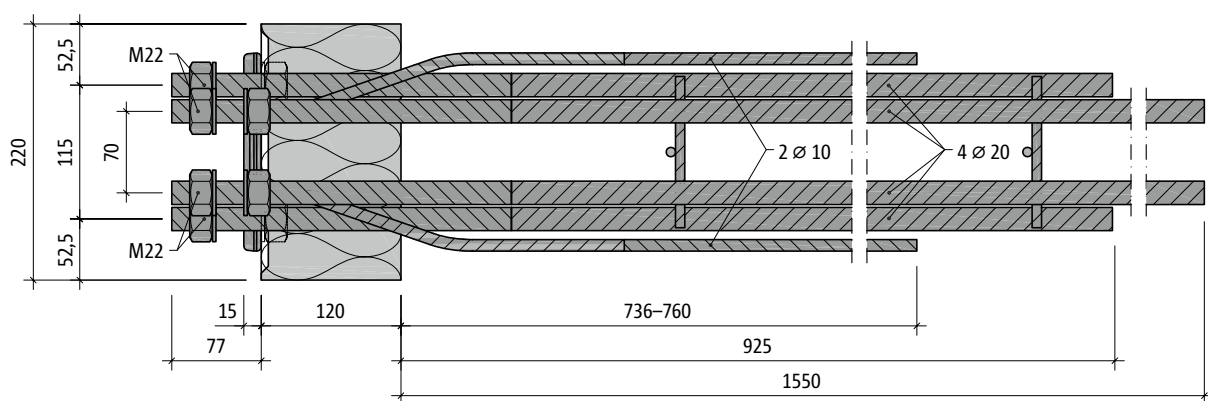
Schöck Isokorb® XT Typ SK-MM2-VV1: Grundriss
